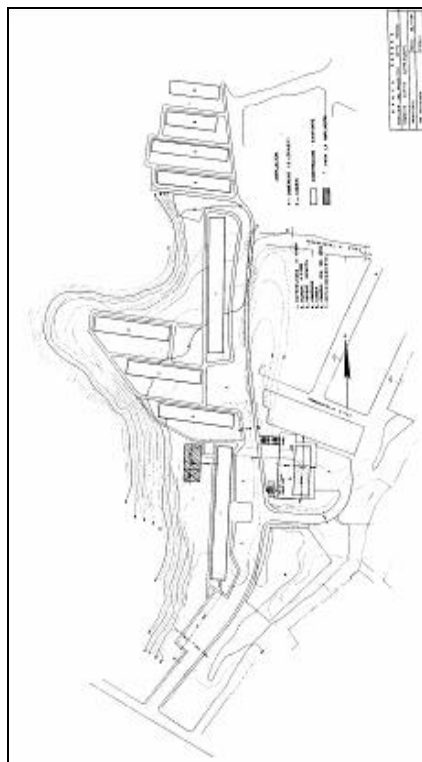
UV Altos de Cútira. Proyecto de Ampliación, 1958. Plano de Conjunto.
